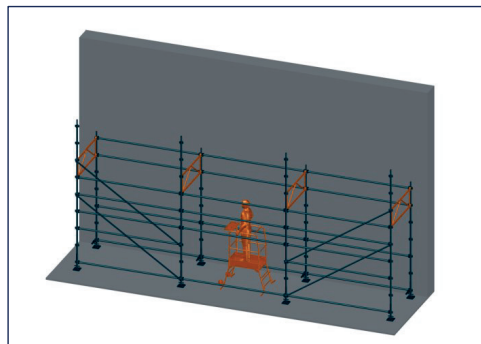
Exemple d'installation des poutres piéton à l'aide d'une PIRL
